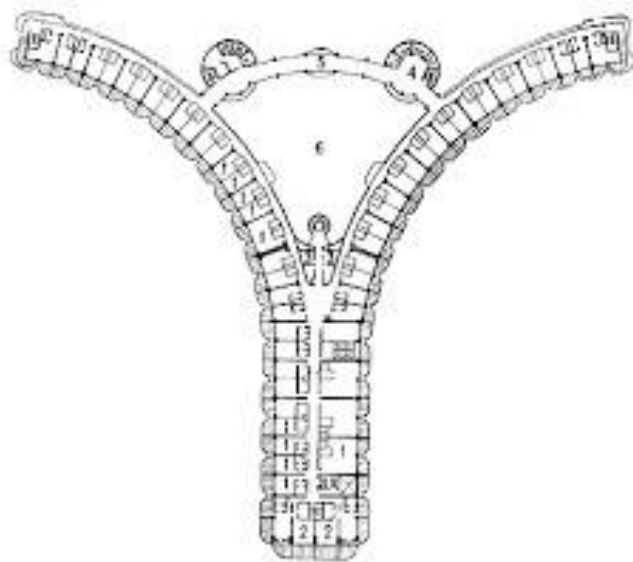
План житлового поверху готелю «Ібусукі» (Івасакі, Японія)
